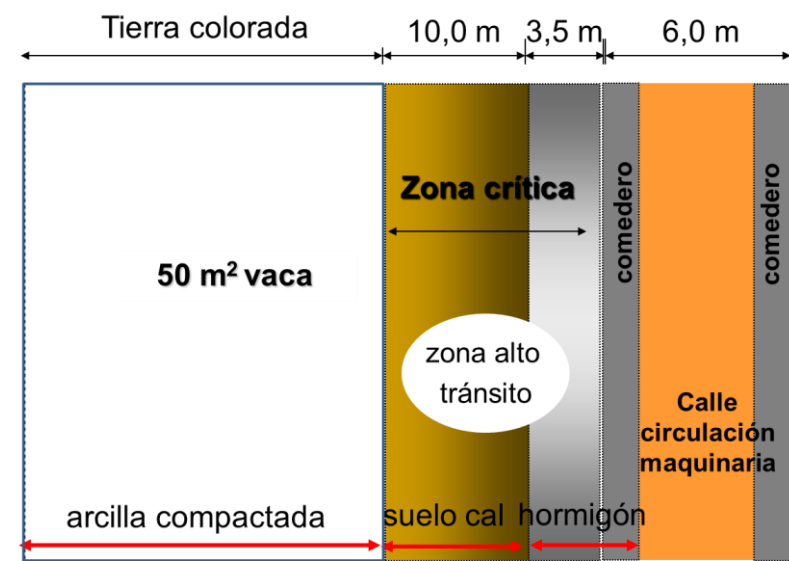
Detalles constructivos del corral estabilizado de alimentación.
